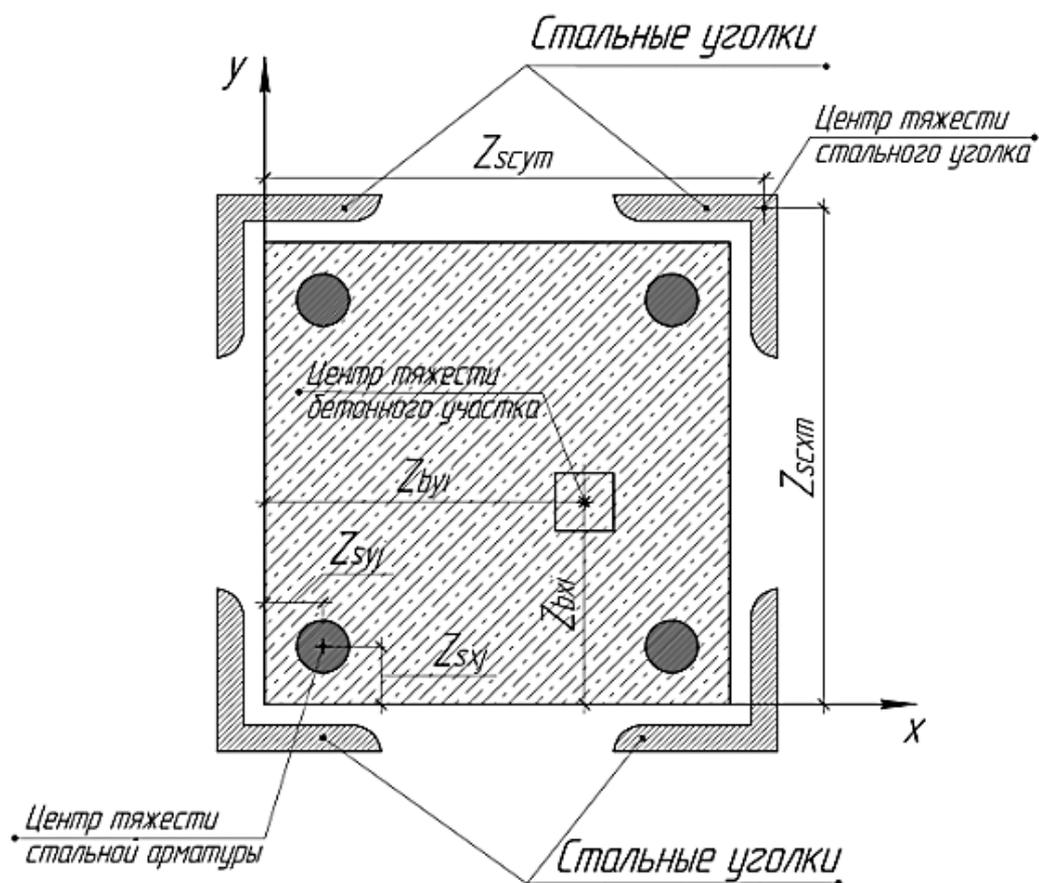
Расчётная схема нормального сечения железобетонной конструкции, усиленной путем присоединения стальных уголков
